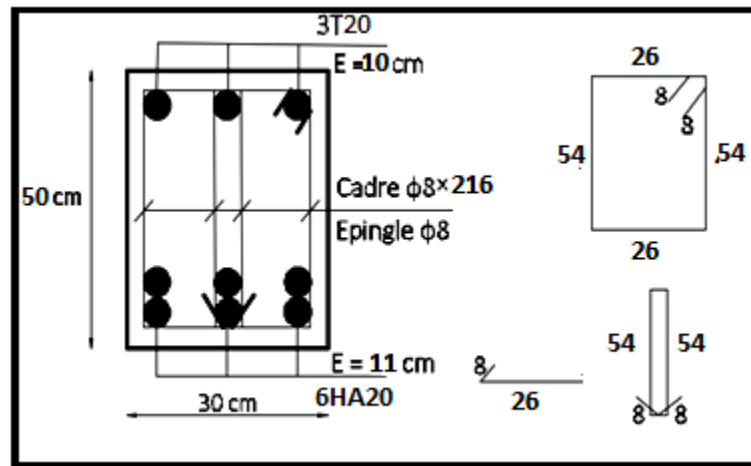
Dessin de ferrailage de la poutre principale en travée.
